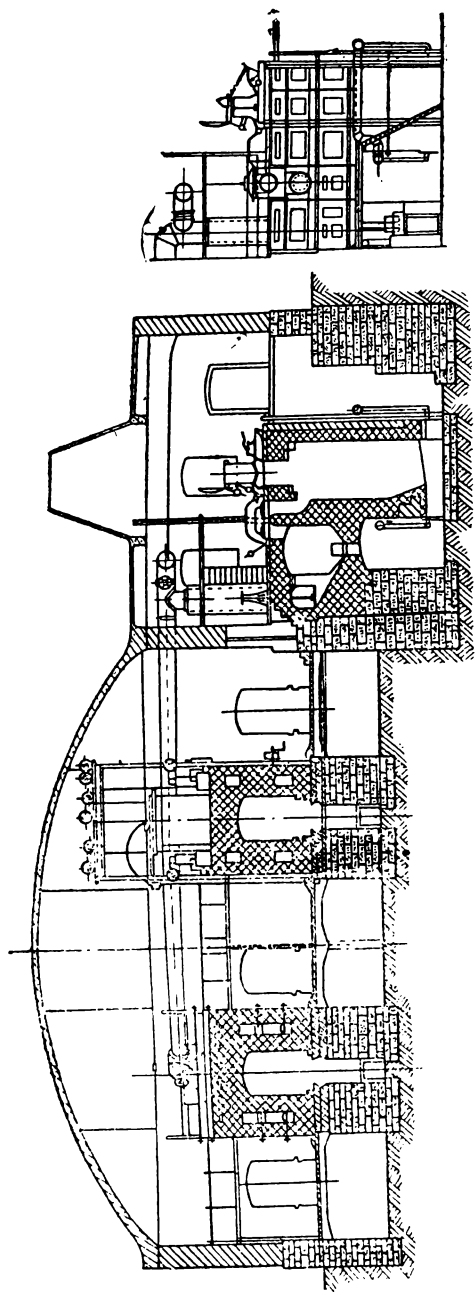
Газогенераторная станция Хайтинской фабрики (и газопровод в туннельный цех)
